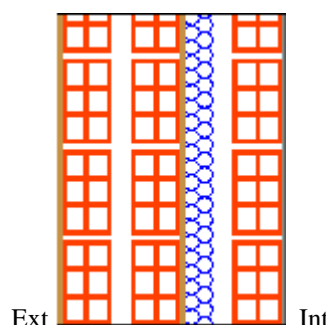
Solução Fach.h 6 - Execução de uma contrafachada pelo interior em alvenaria
